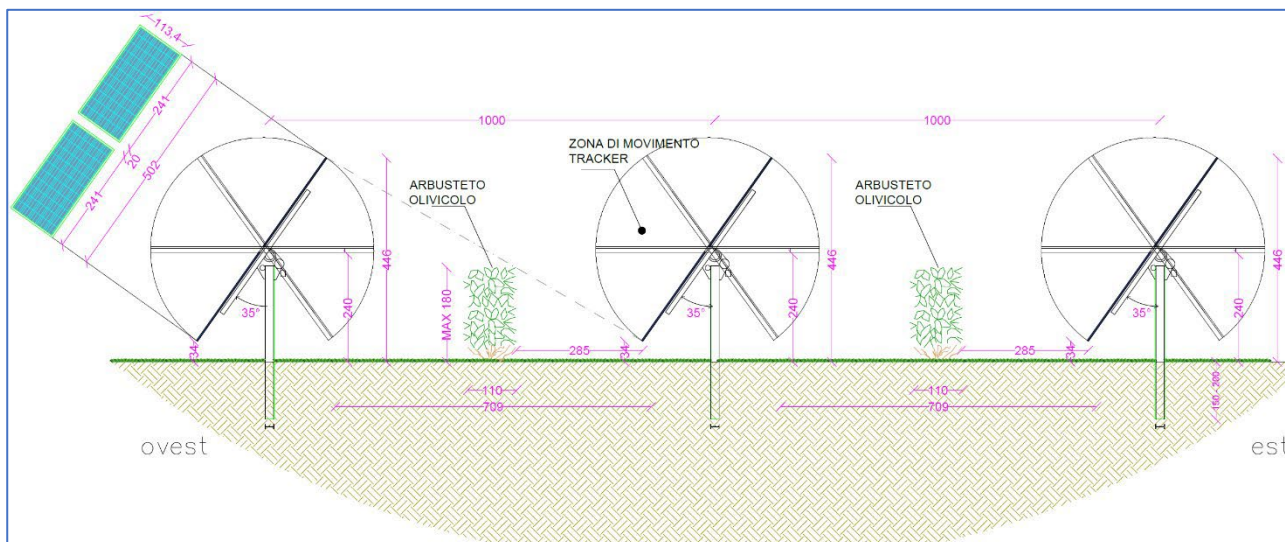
Sezione tipo impianto con installazione su sistema ad inseguimento solare tipo tracker
